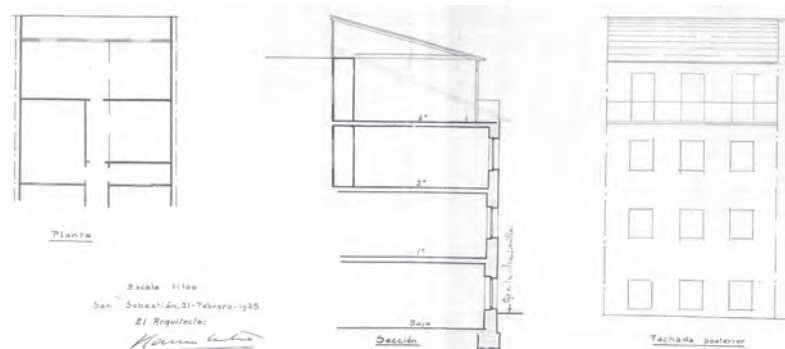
21. 1925 PLANTA, SECCIÓN Y ALZADO TRASERO DE EDIFICIO REFORMADO
